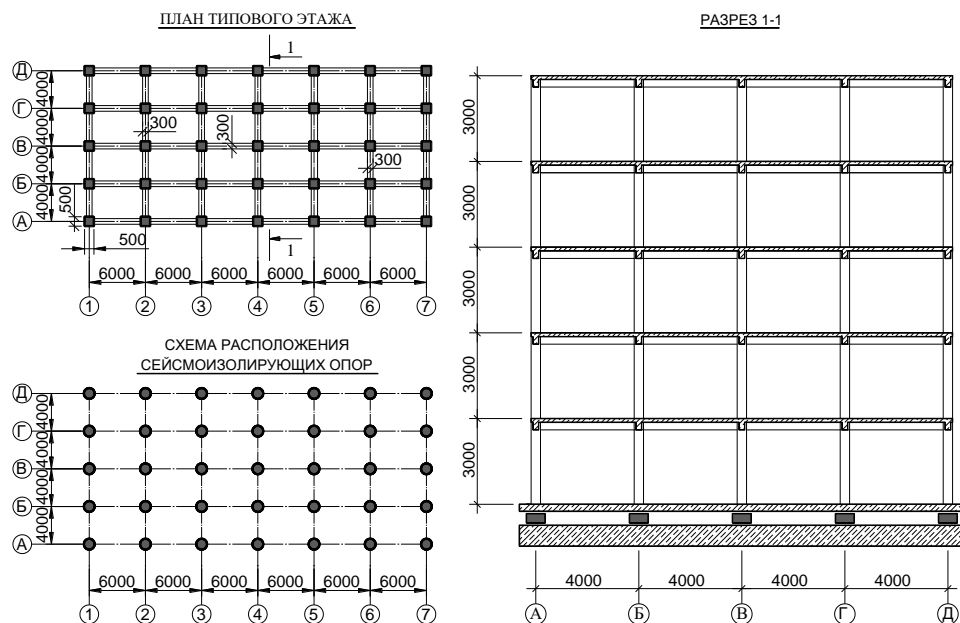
Принципиальное конструктивно-планировочное решение здания с сейсмоизолирующим фундаментом
